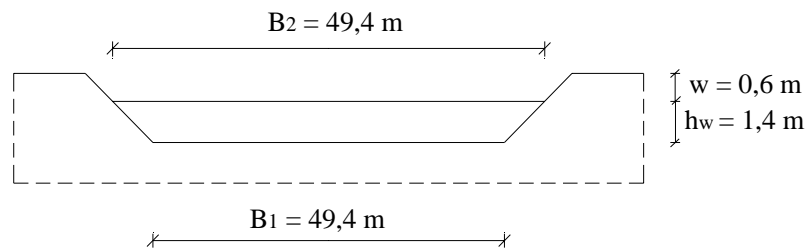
Sketsa lebar peluap dan tinggi limpasan main dam
